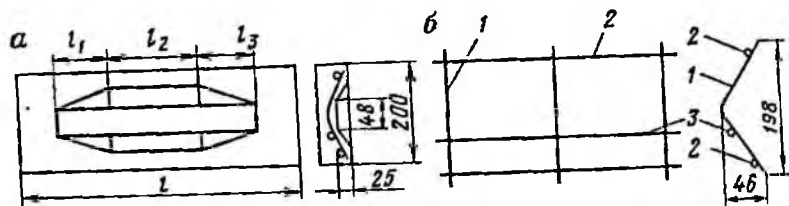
Кессонная железобетонная затяжка ЗК:
